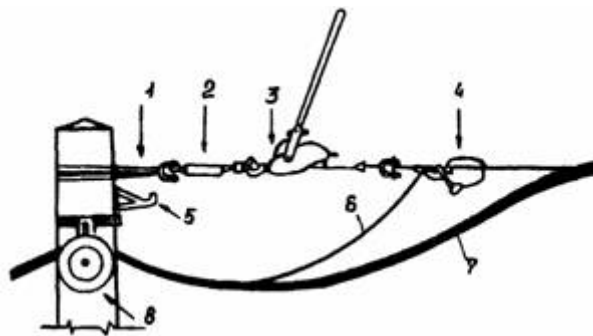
Схема натягивающего приспособления на вершине опоры:
